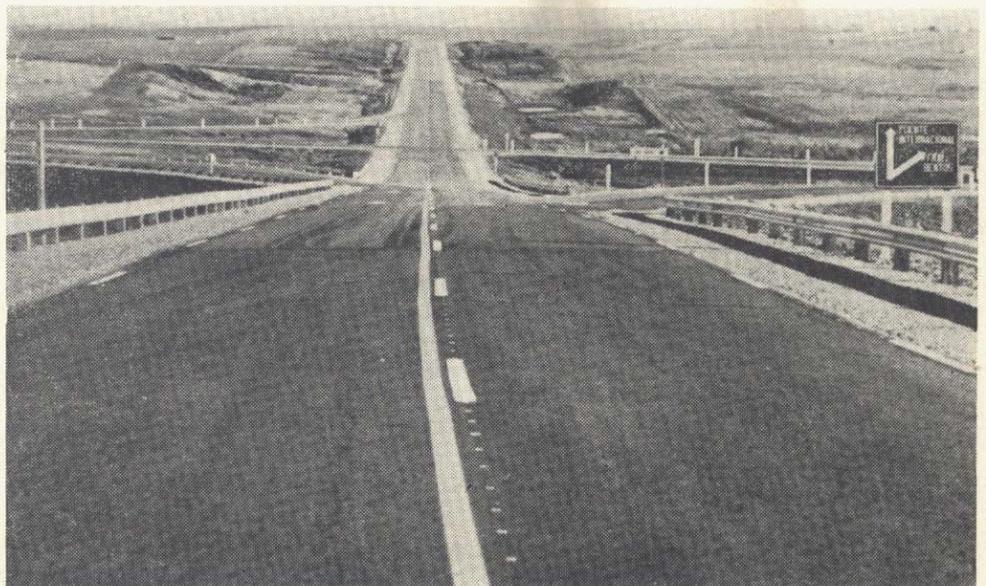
Acceso uruguayo. Pavimento terminado en intersección: Puente Internacional - Fray Bentos.
